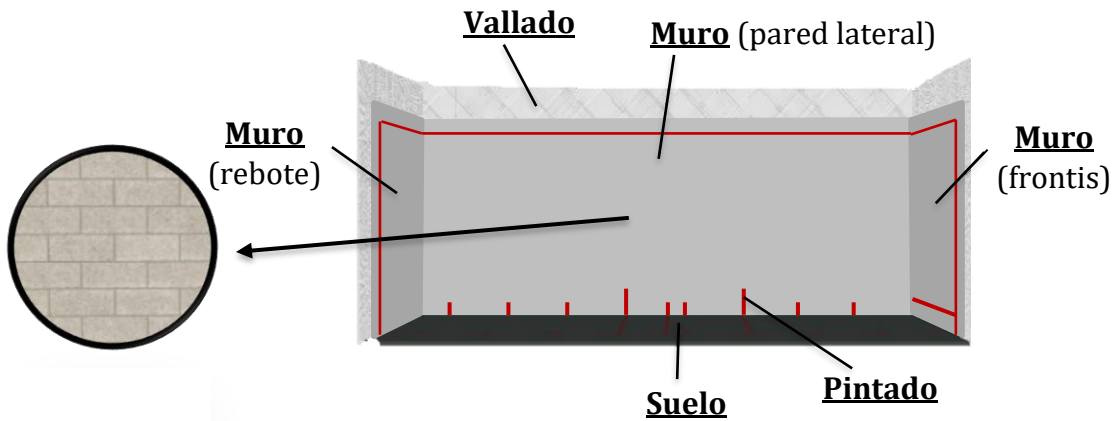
Fase 1 del frontón cubierto con pared de muro
